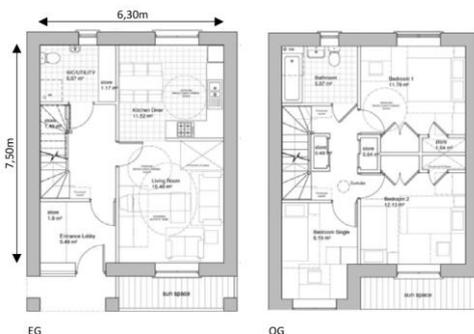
Grundrisse (Architekten: PRP Architects) (PRPArchitects 2010)
